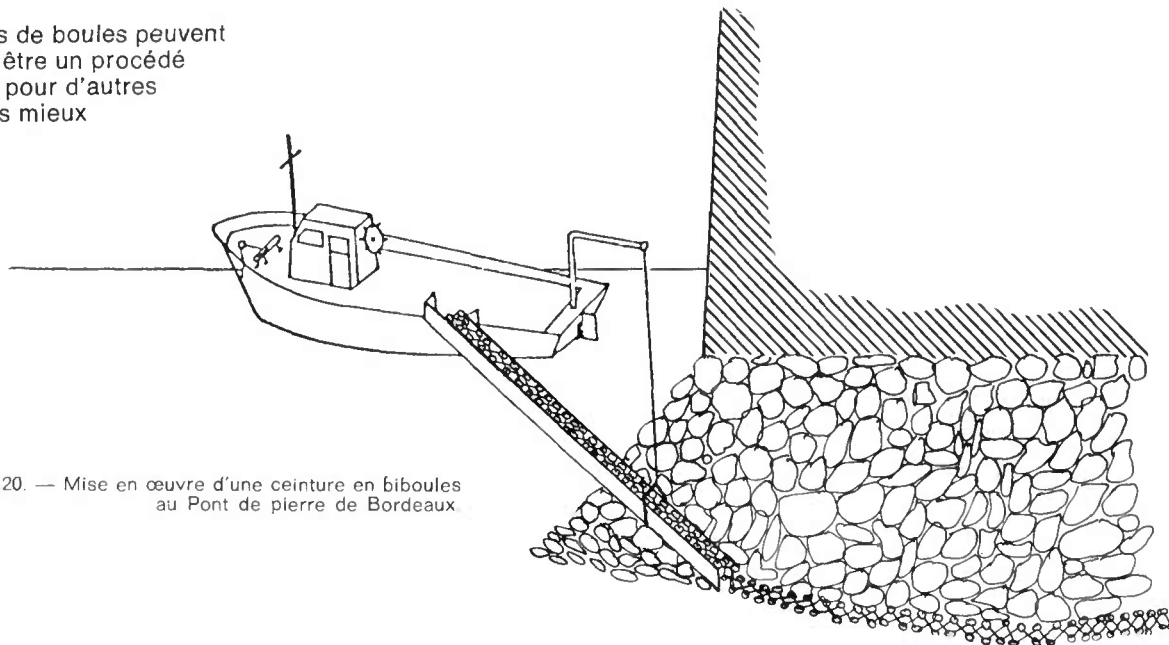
Mise en œuvre d'une ceinture en biboules au Pont de pierre de Bordeaux.
